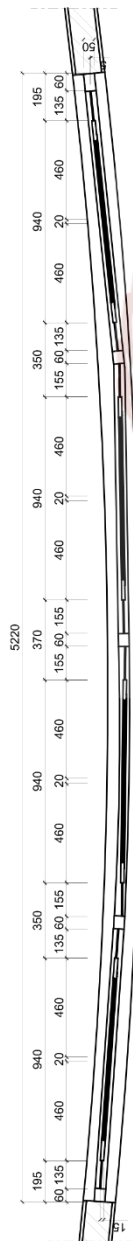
DETAIL PERTEMUAN ANTAR DAUN JENDELA
